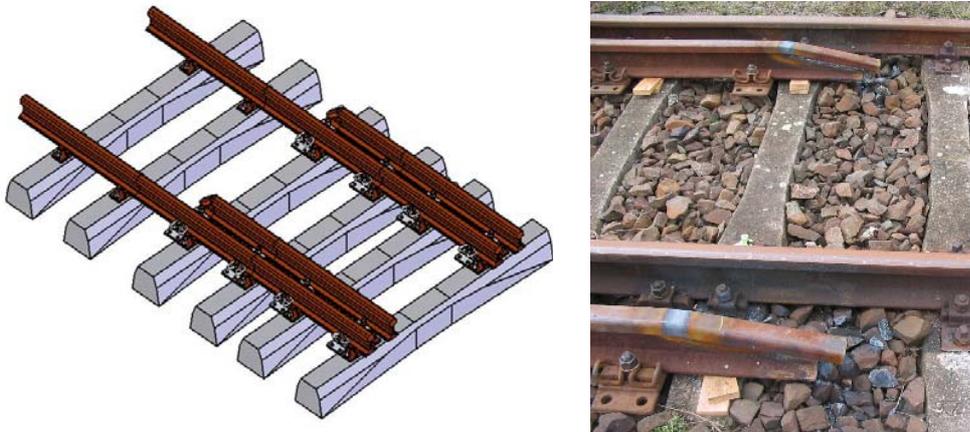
Hilfskonstruktion der Beschleunigungsstrecke mit Rampe
